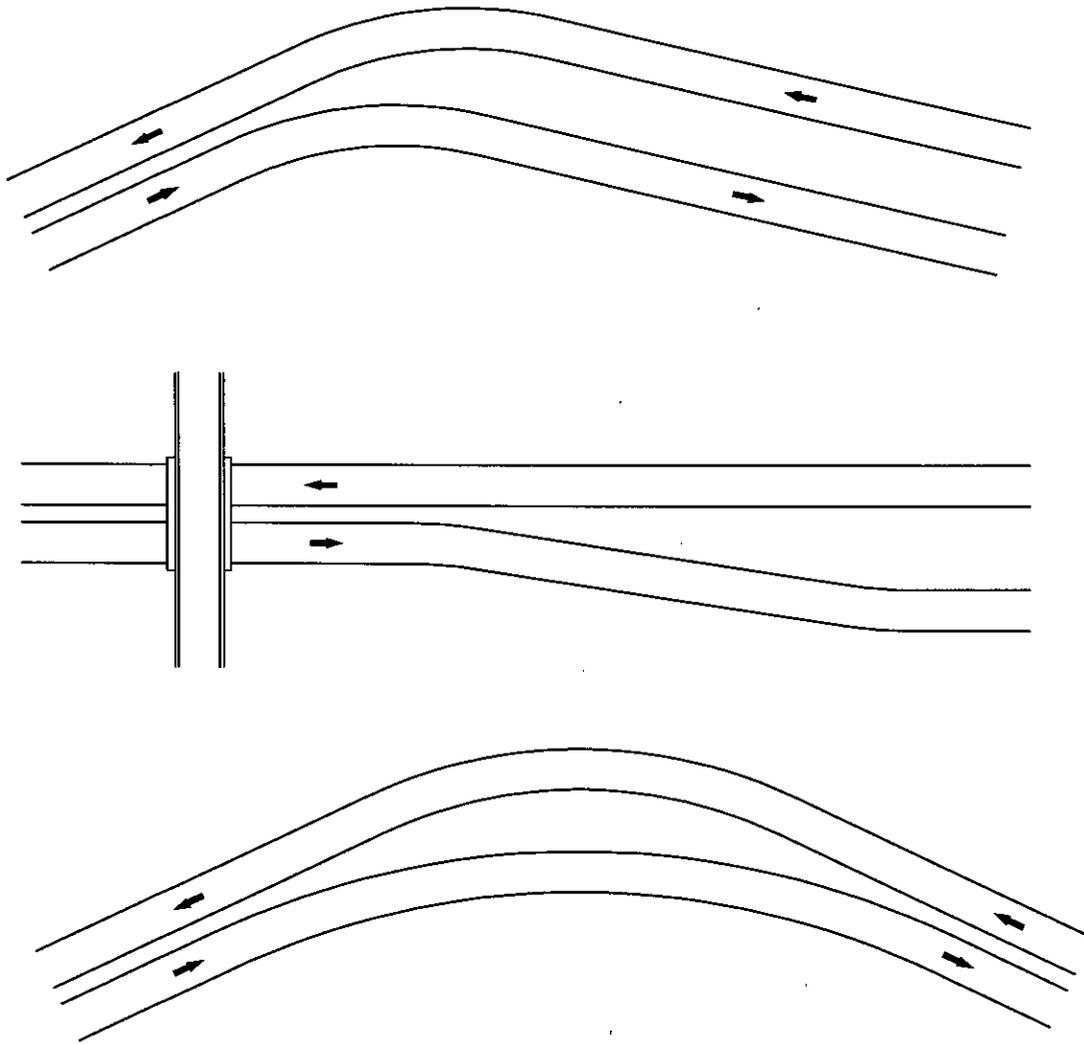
Transiciones recomendadas en el ancho del separador central
